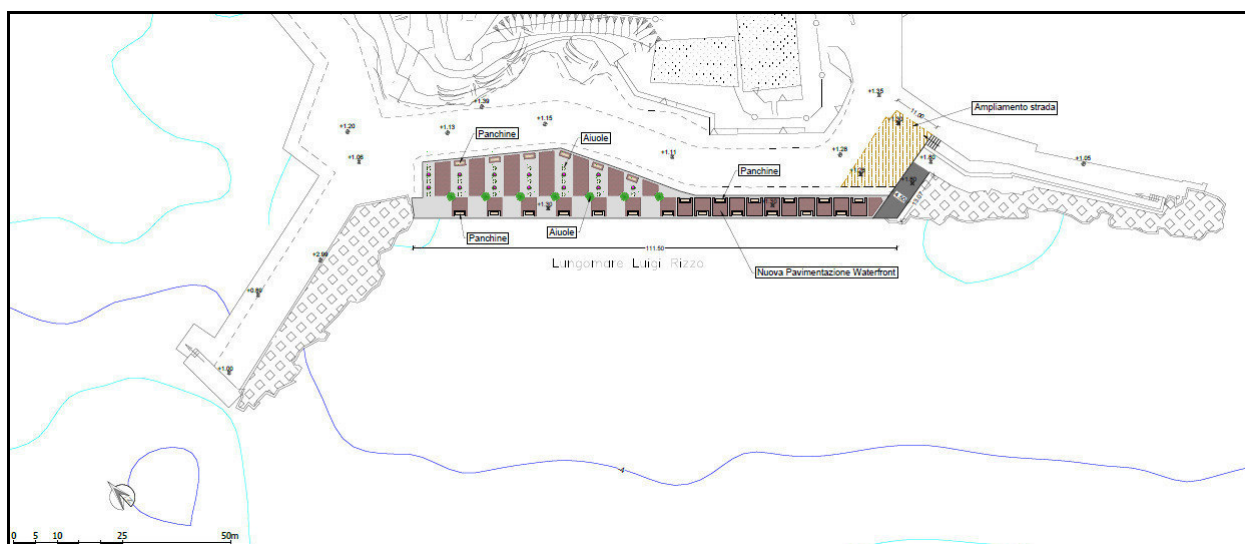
planimetria di progetto dell'adeguamento della banchina tra i moli Madonna e Sanità (fuori scala)
